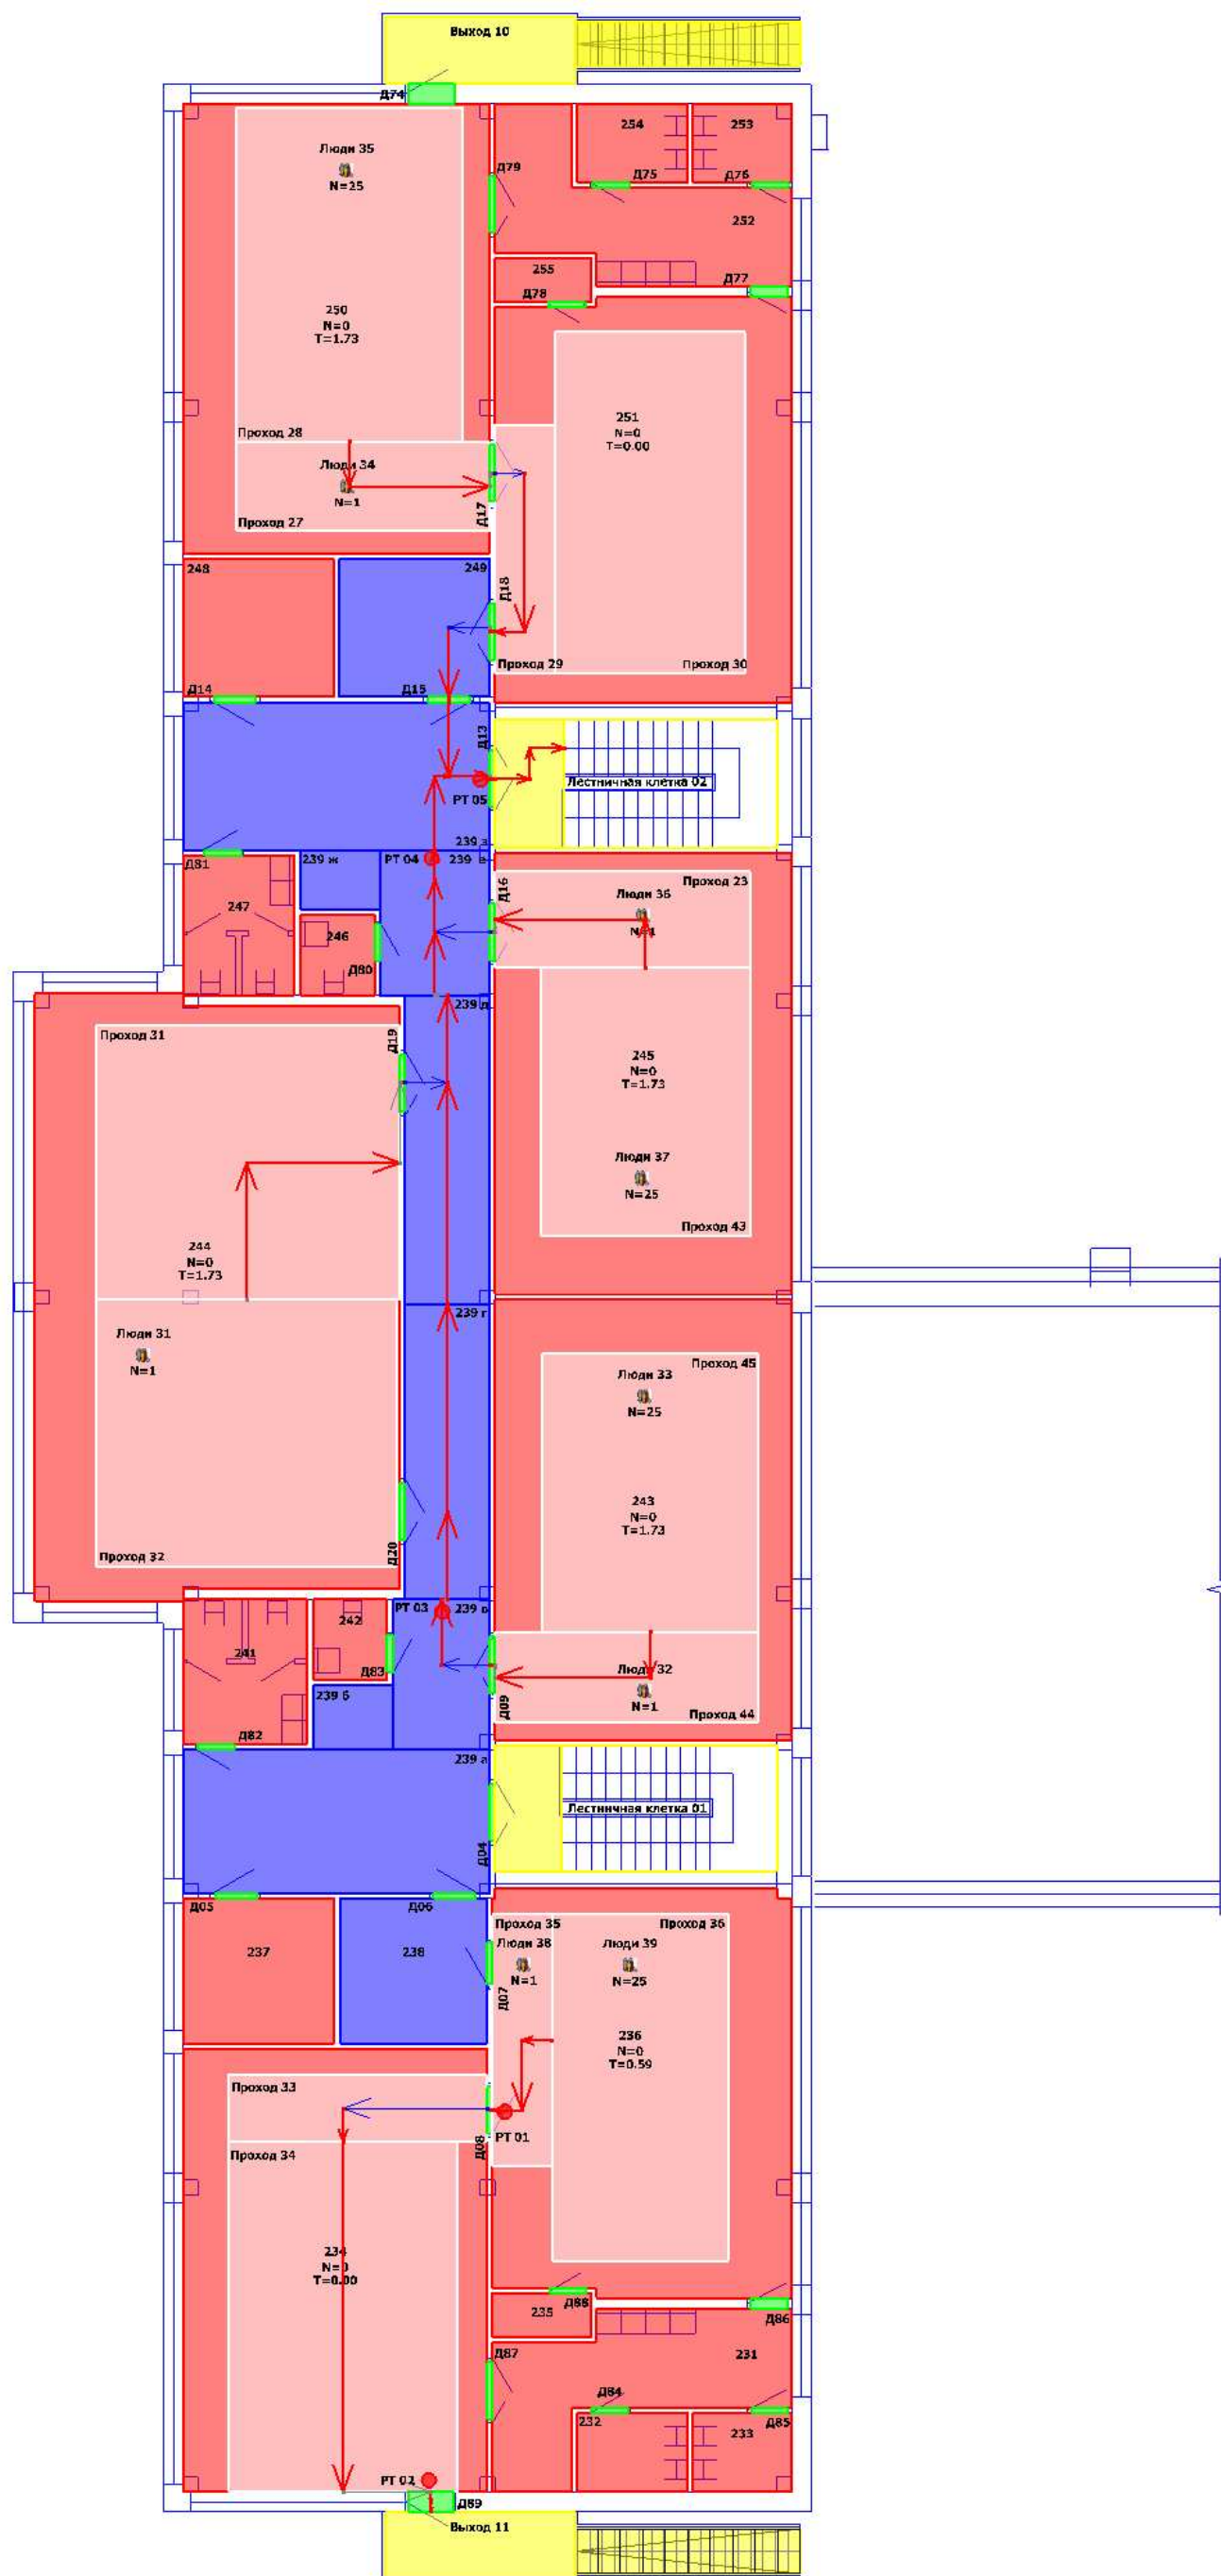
Расчетная схема эвакуации из помещений 2-го этажа здания Детского сада на 60 мест с начальной школой на 100 учащихся (Сценарий 02)
